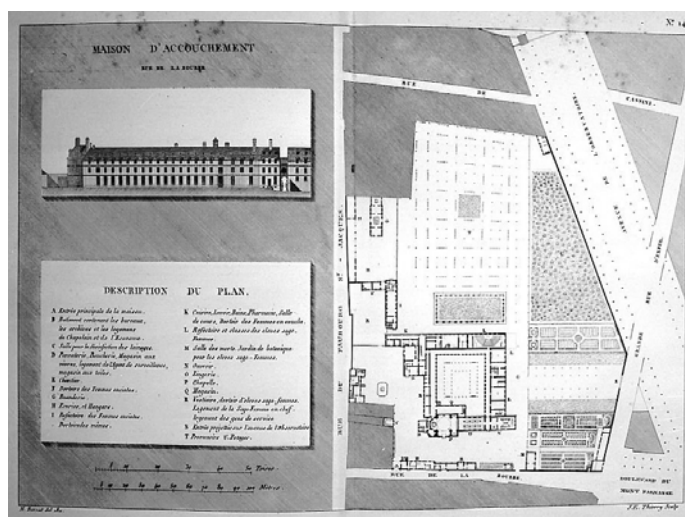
Projeto arquitetônico com fachada e planta baixa da *Maison de Accouchement*, Paris, 1820. Fonte: BIUM, n° 09589, 2007.
